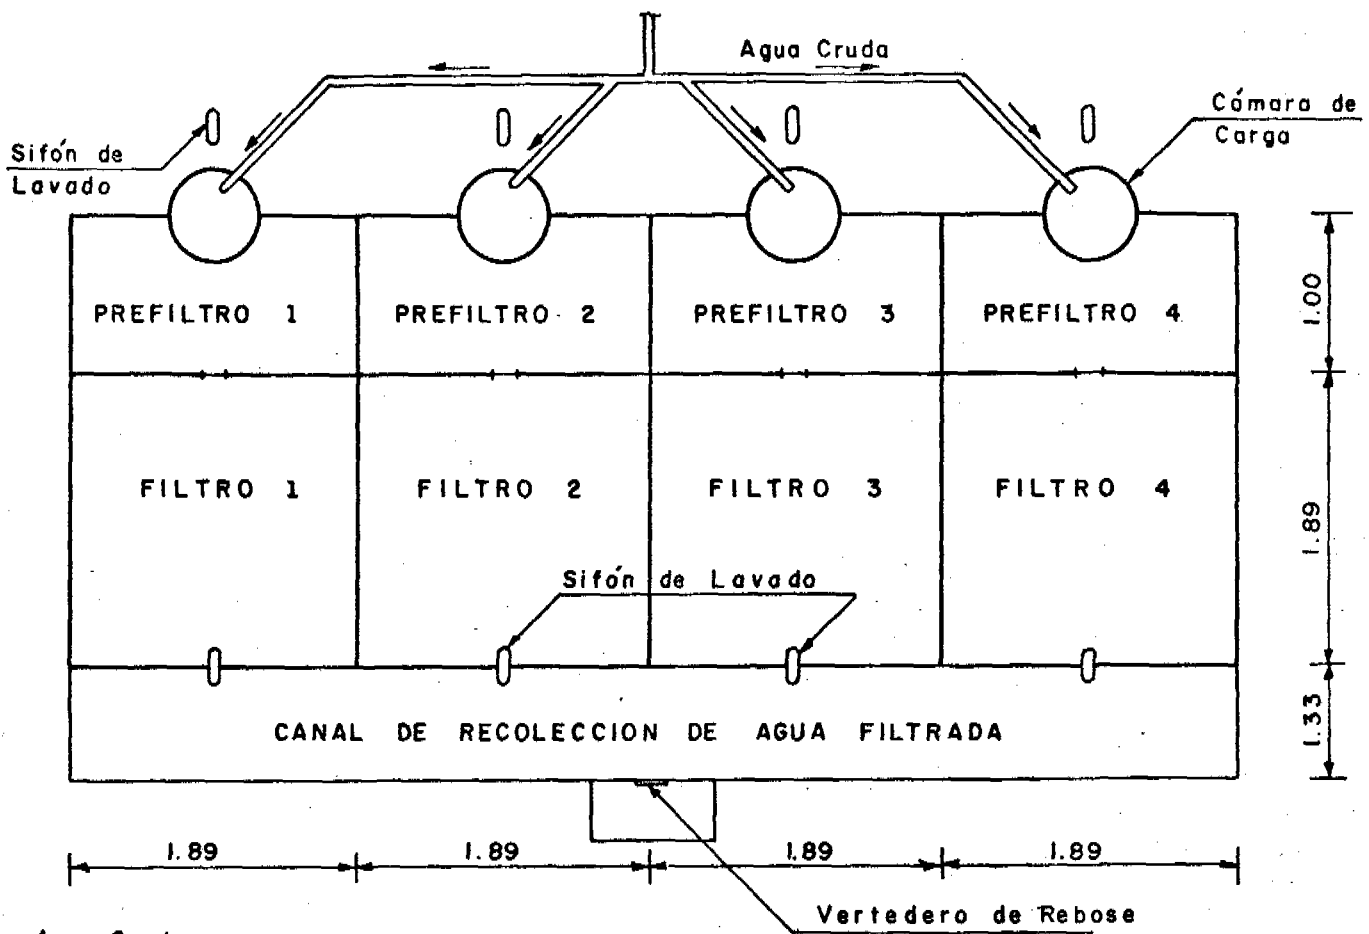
PREFILTRO ASCENDENTE CON AUTOLAVADO DESCENDENTE Y FILTRO LENTO RECTANGULAR DESCENDENTE CON AUTOLAVADO ASCENDENTE
